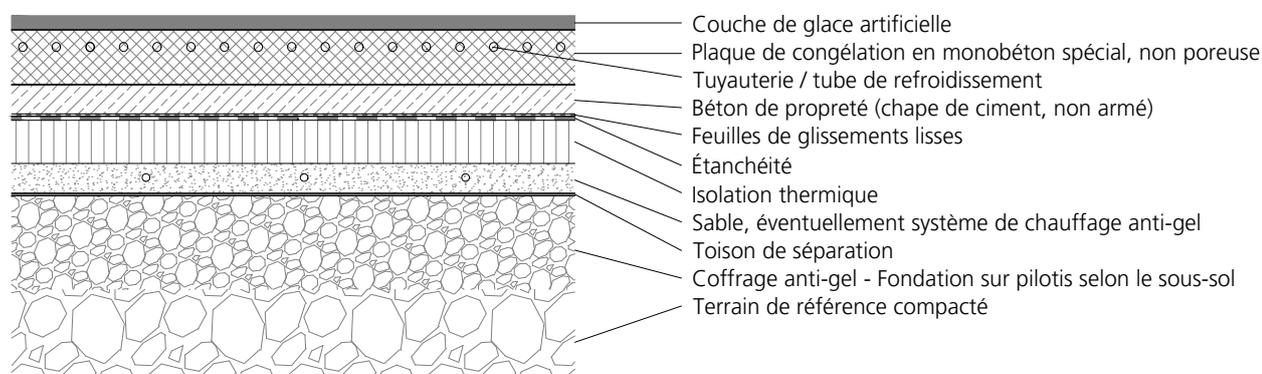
Exemple de construction d'une dalle de froid sur un support sec et solide (étanche)
